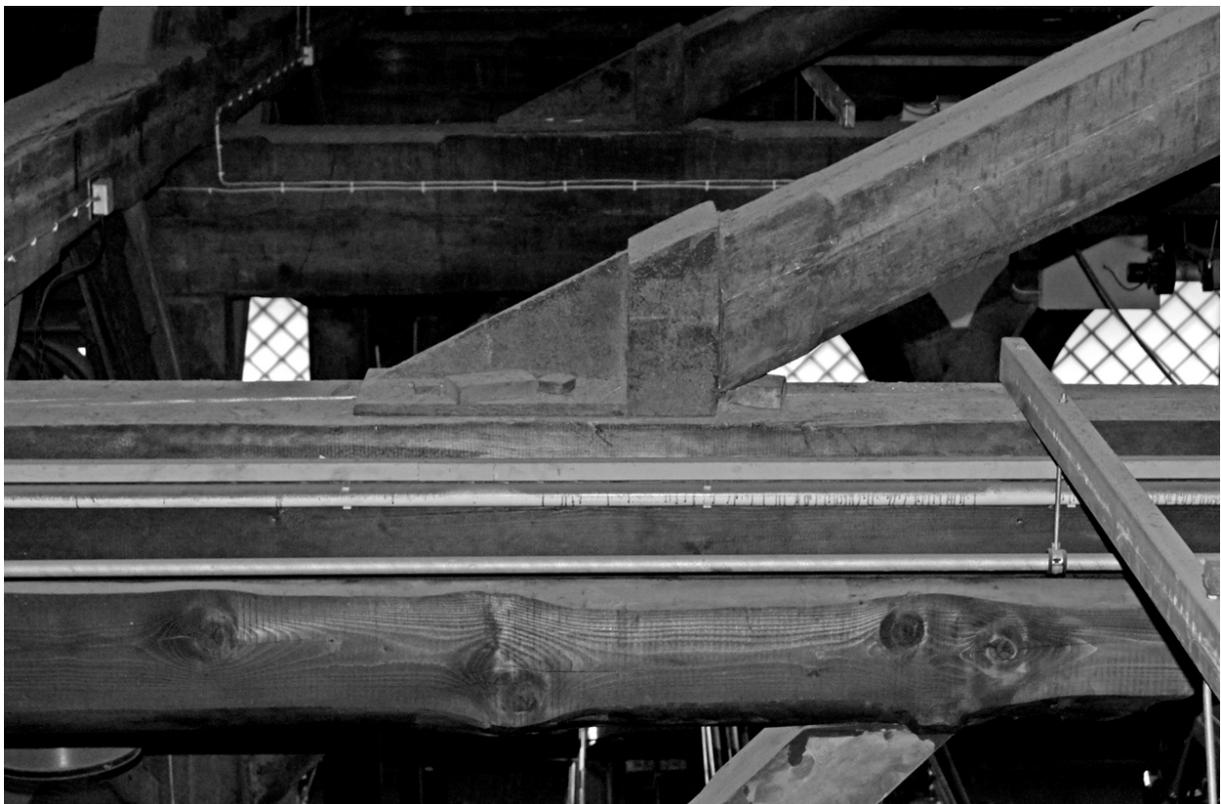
Einsteighalle in Hof, Eisenschuh als Verbindungsdetail von Strebe und Zerrbalken
